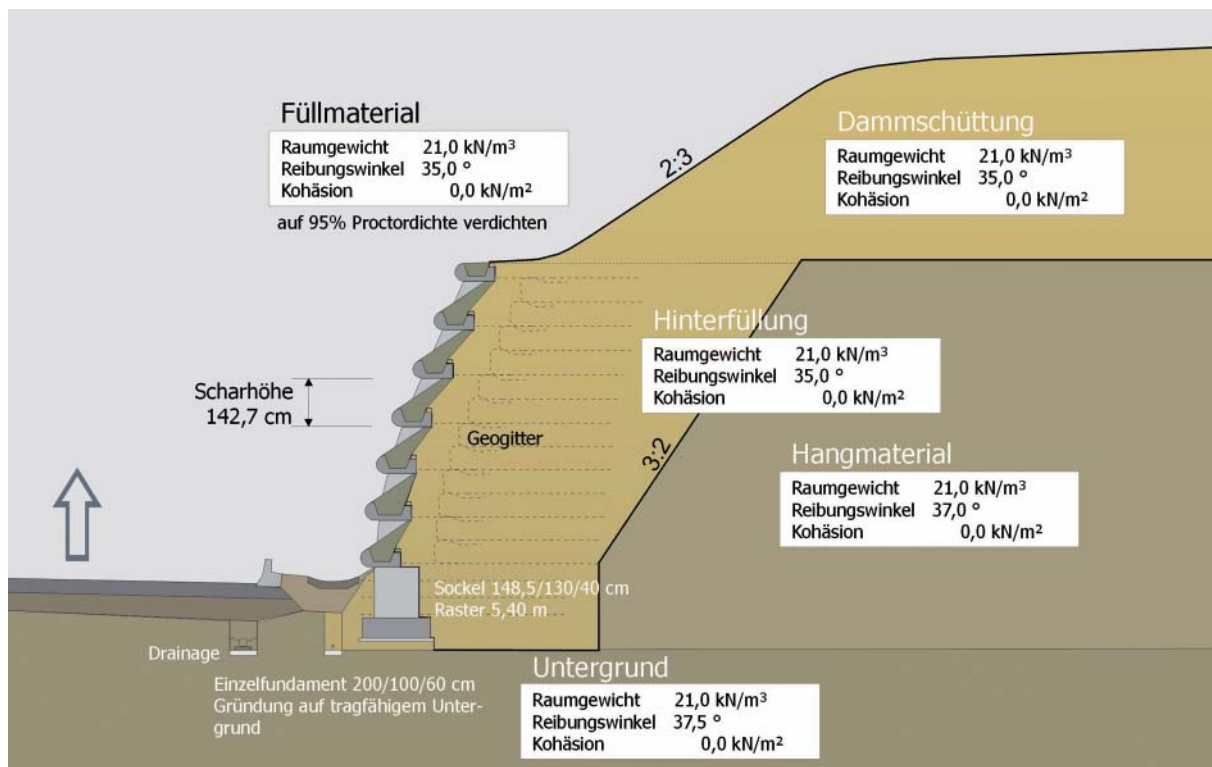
Ausgeführter Regelquerschnitt „Welser Verbau“
